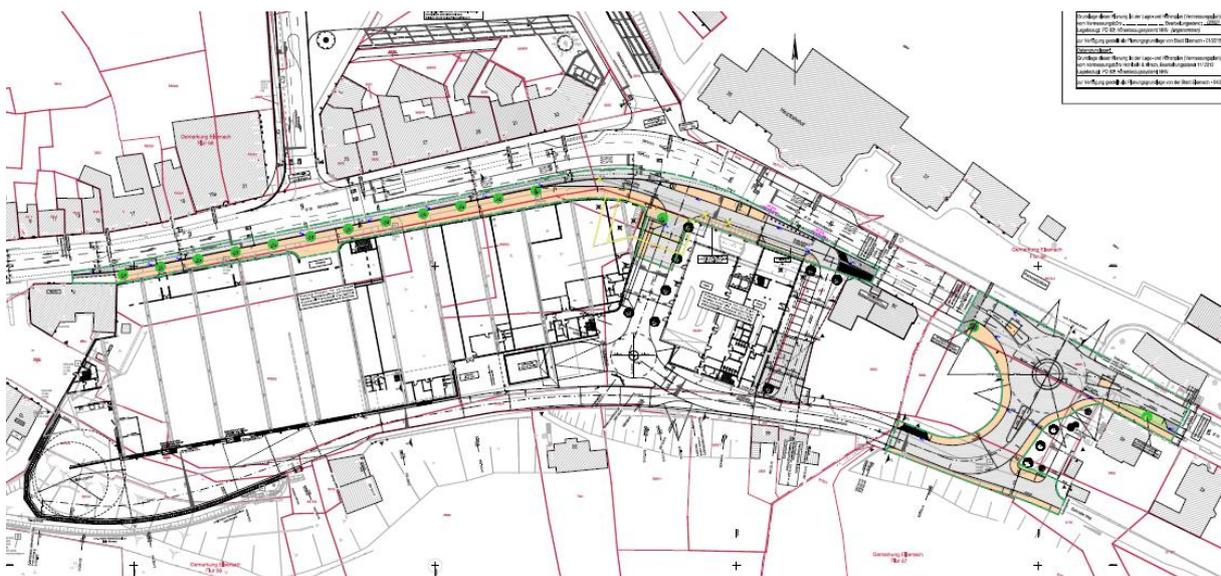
Lageplan Planung Verkehrsanlagen „Tor zur Stadt“, IB Ruppe, 07/2017
